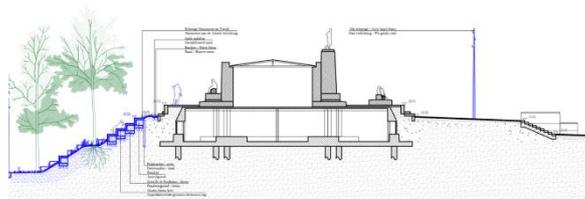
sit. projetée – coupe extr. du dossier de demande
